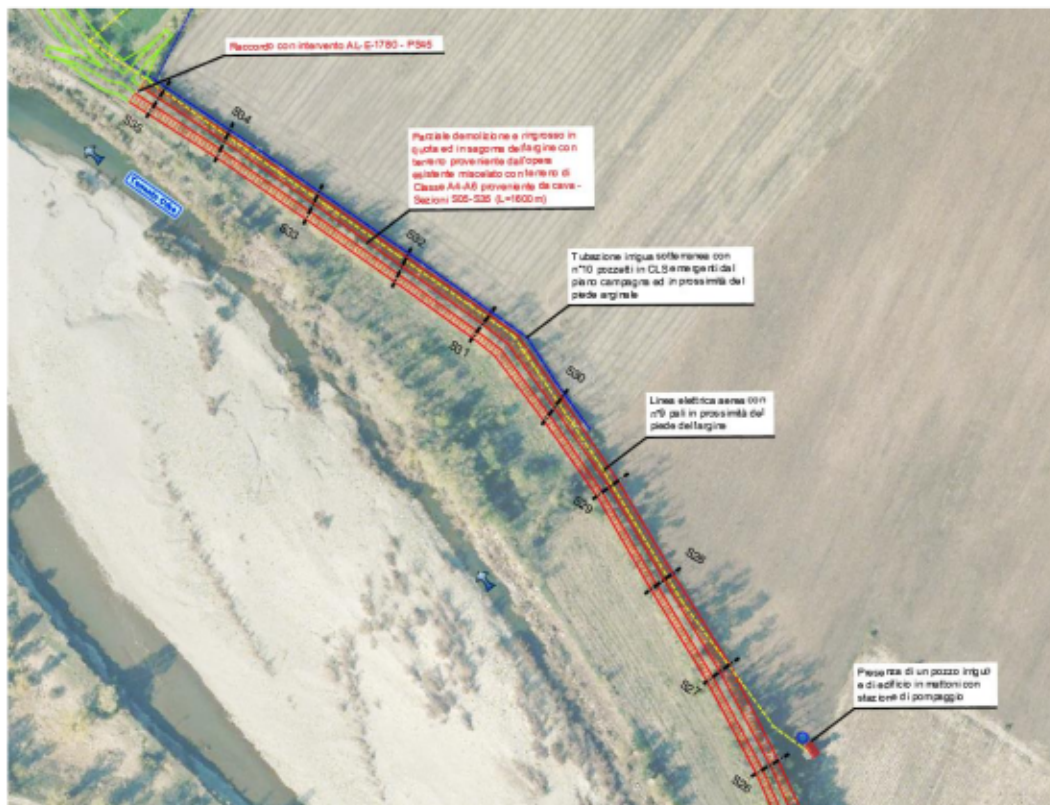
ESTRATTO DELLA PLANIMETRIA DI PROGETTO DELL'INTERVENTO N°1 TRA LE SEZIONI S35 ED S26
